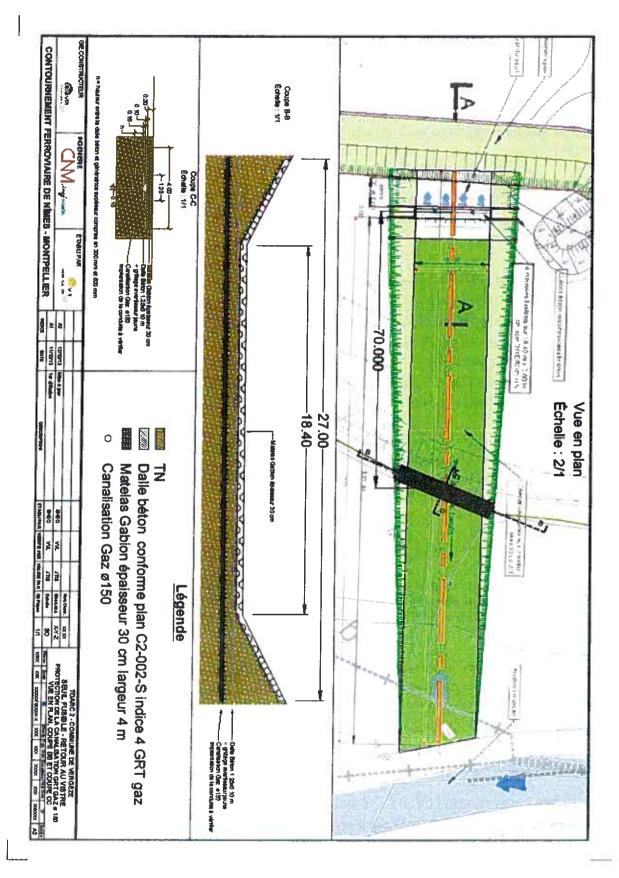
Plan du déversoir entre la gravière E et le Vistre
